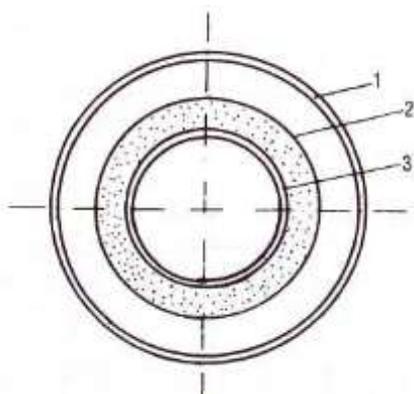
Конструкция трубопровода типа «труба в трубе» с теплоизоляцией внутренней трубы: 1,3 — наружная и внутренняя трубы; 2 — теплоизоляция
